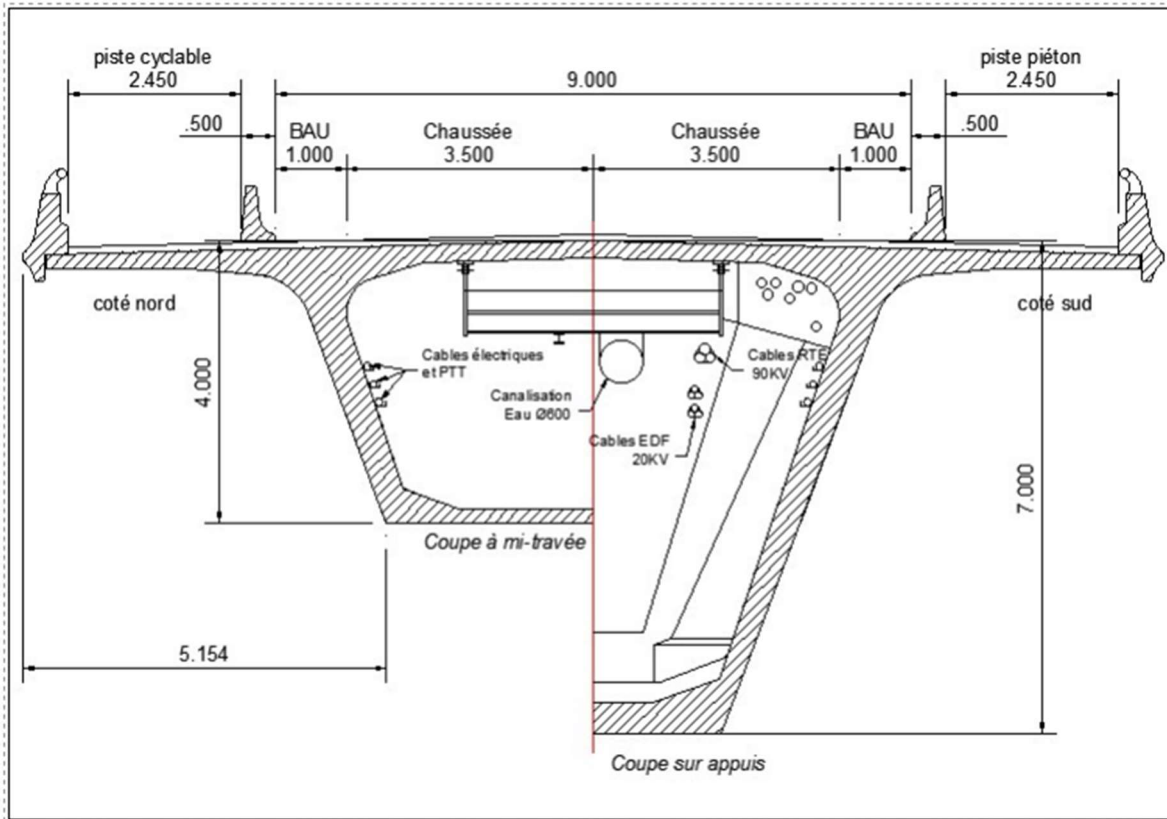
Profil en travers du pont de l'île de Ré (coupe existante)
